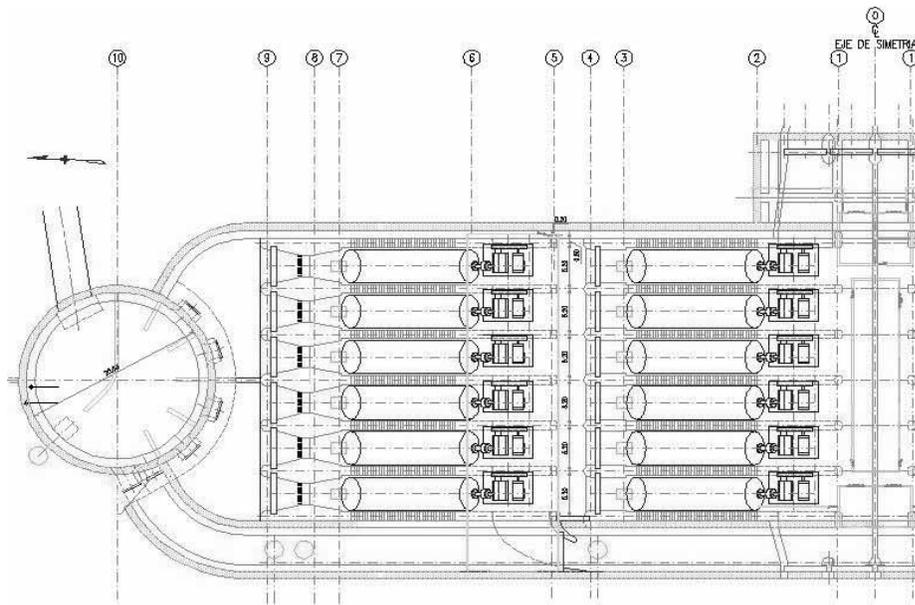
Vista en planta de la mitad de la estación de bombeo
